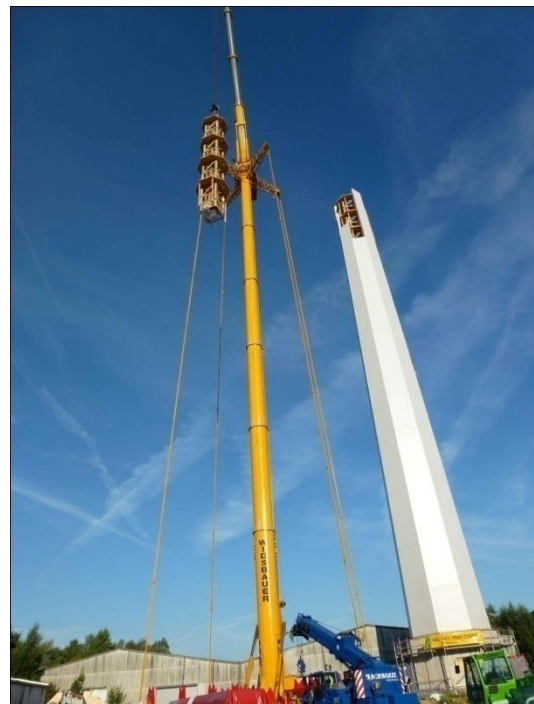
Ensamblaje de una torre de madera (TimberTower GmbH)
